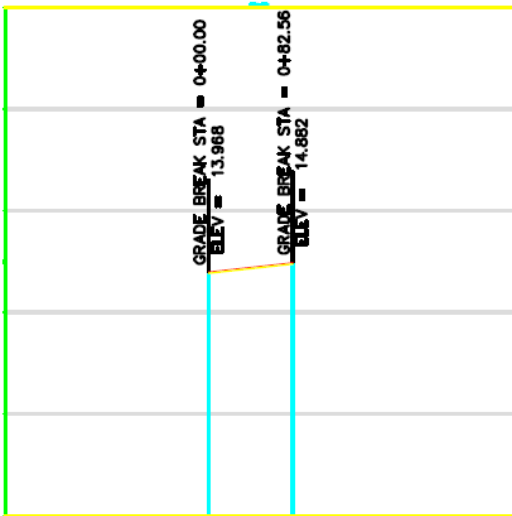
Perfil longitudinal tuberías eje 4 y 5
